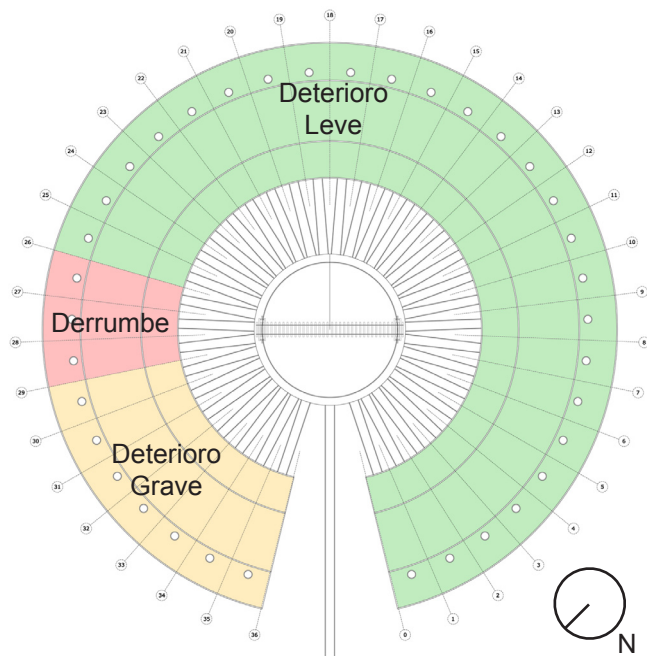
Elaboración propia a partir de planimetría original Casa de Máquinas de Temuco y medidas tomadas en terreno
